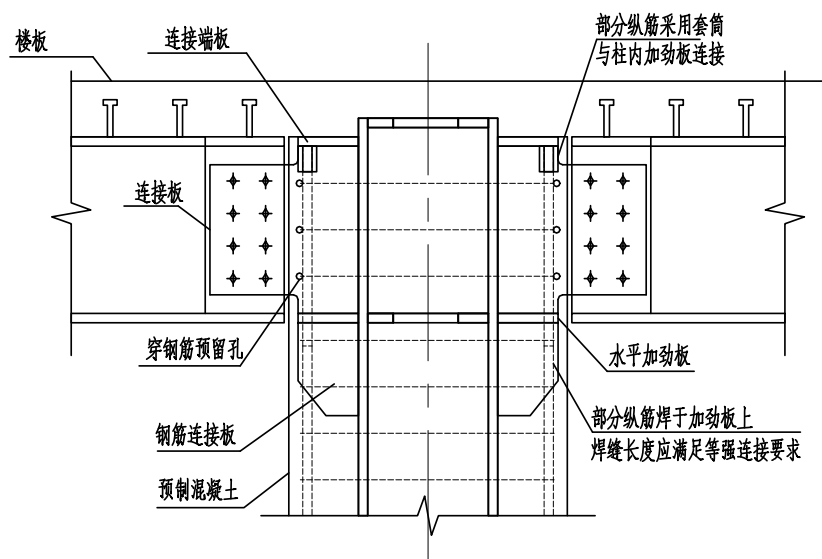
预制型钢混凝土柱与梁连接节点的构造
